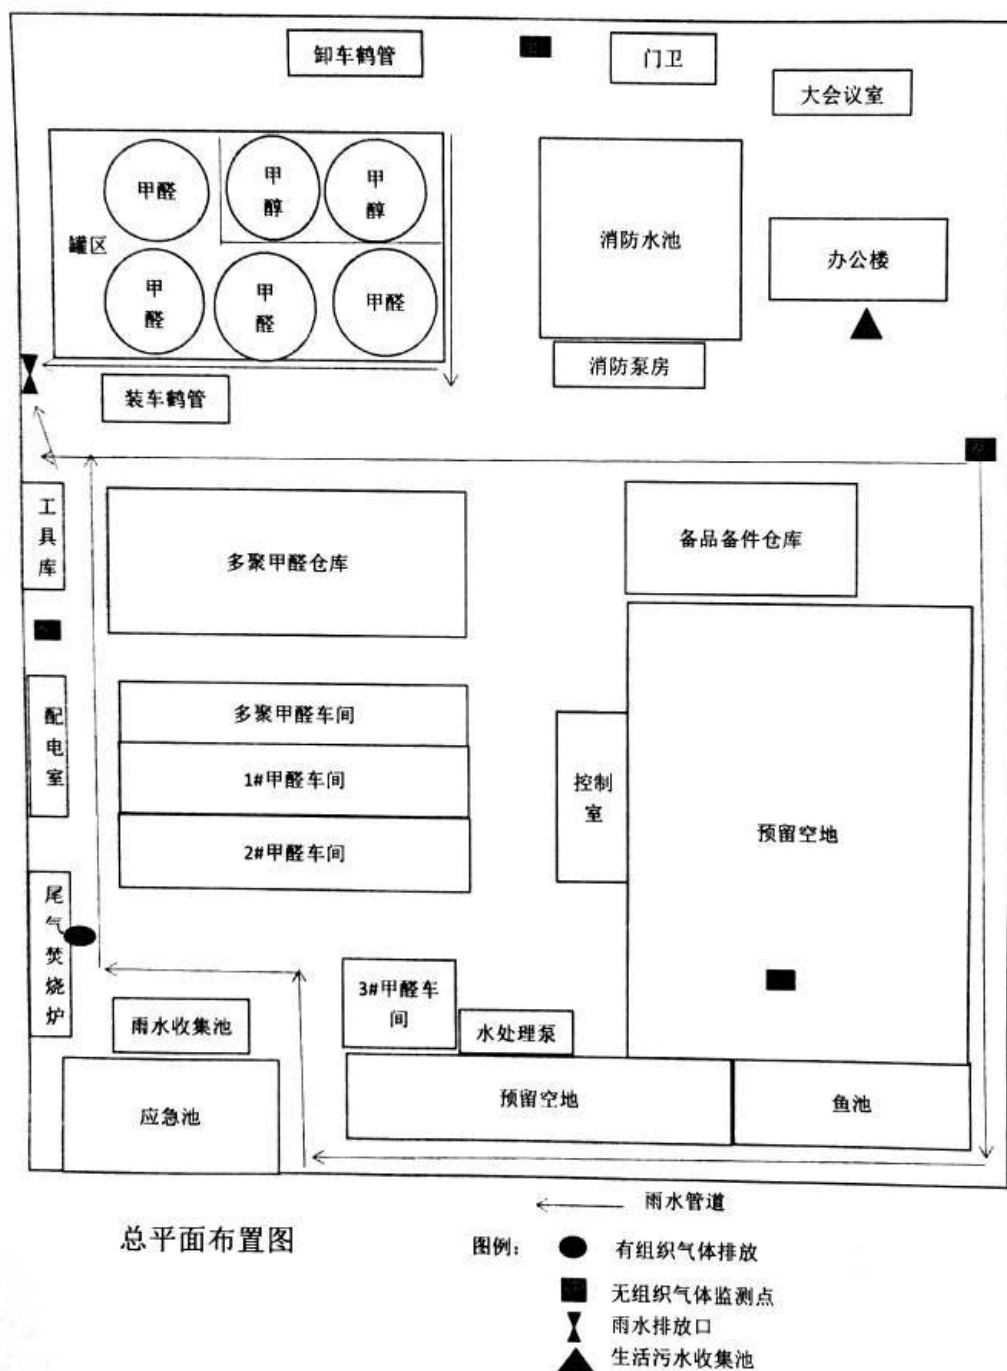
现有项目平面布置、废气收集管线及雨污管网图
